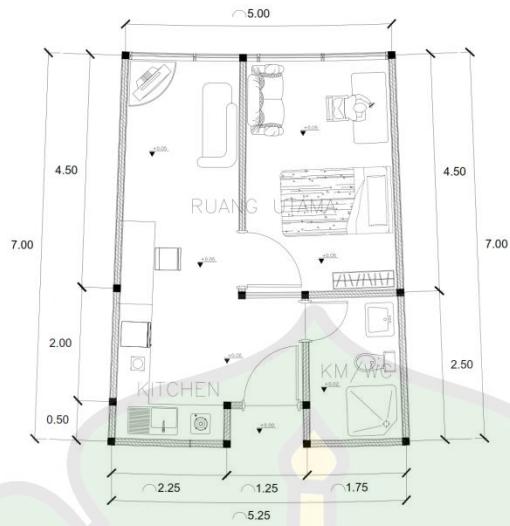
Denah Unit Apartemen Studio Type C
